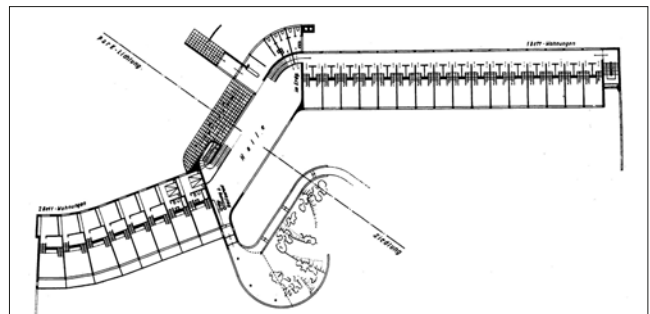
Breslau, Ledigenheim auf der Werkbundausstellung, Hans Scharoun, 1929, Grundriss
